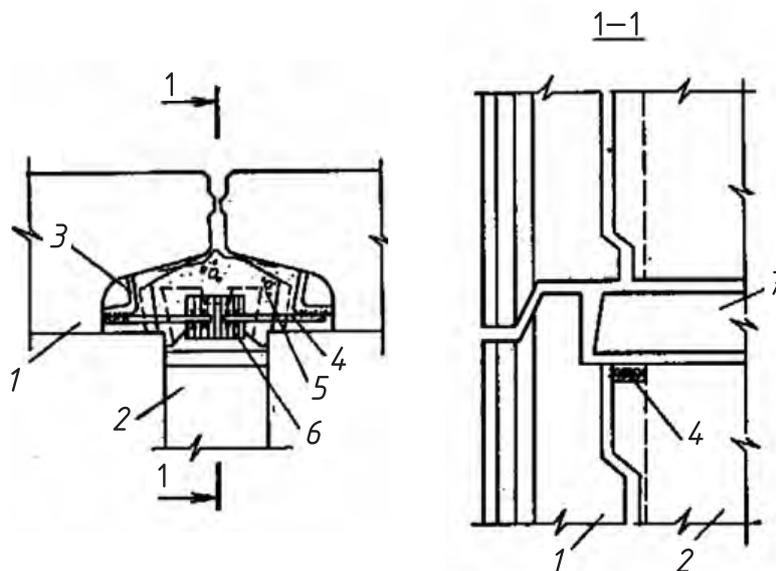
Конструкция связей сварная: 1 — панель наружной стены; 2 — панель внутренней стены; 3 — петлевой арматурный выпуск; 4 — стыковая накладка; 5 — бетон замоноличивания; 6 — стальная закладная деталь; 7 — панель перекрытия
